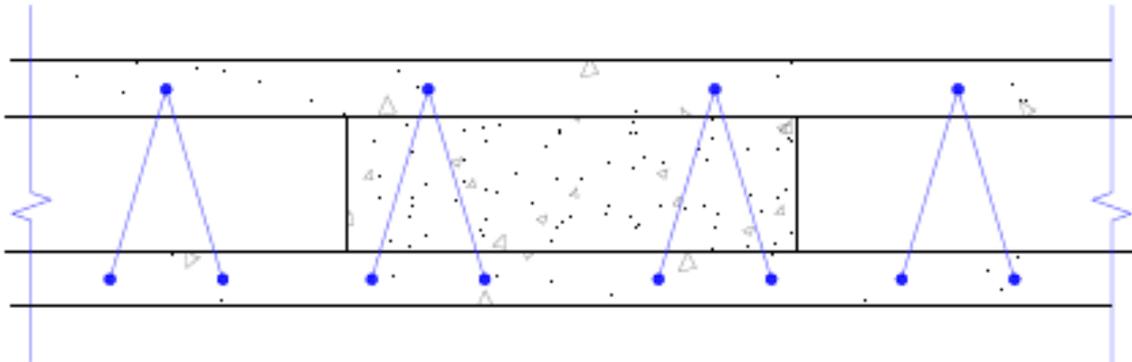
Seção transversal painel sanduíche sem ligações rígidas
